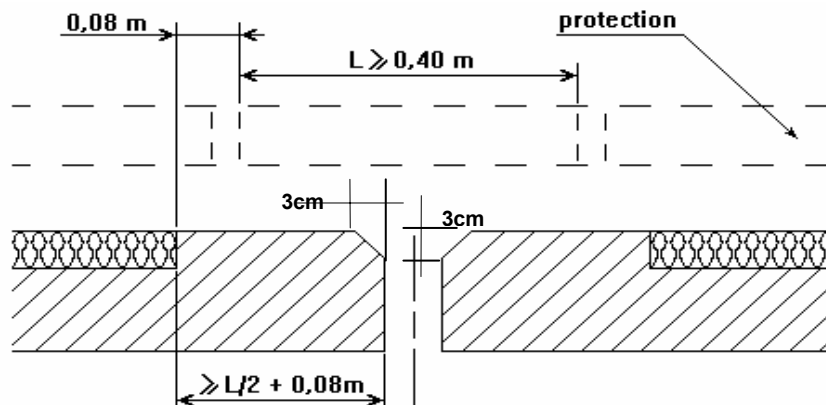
Terrasses accessibles aux piétons et séjour - dimensionnement de la retenue en béton
